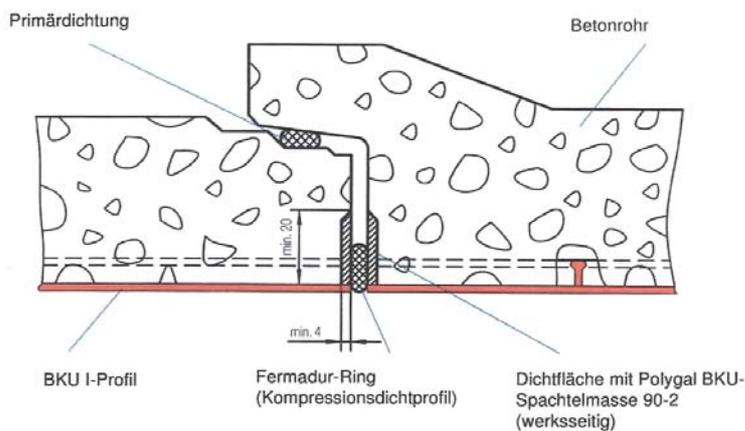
Verbindungsbereich von Betonrohren mit Innenauskleidung des Typs BKU I, Ausführungsbeispiel 2: Fermadur-Ring als Sekundärdichtung (vgl. [103])
